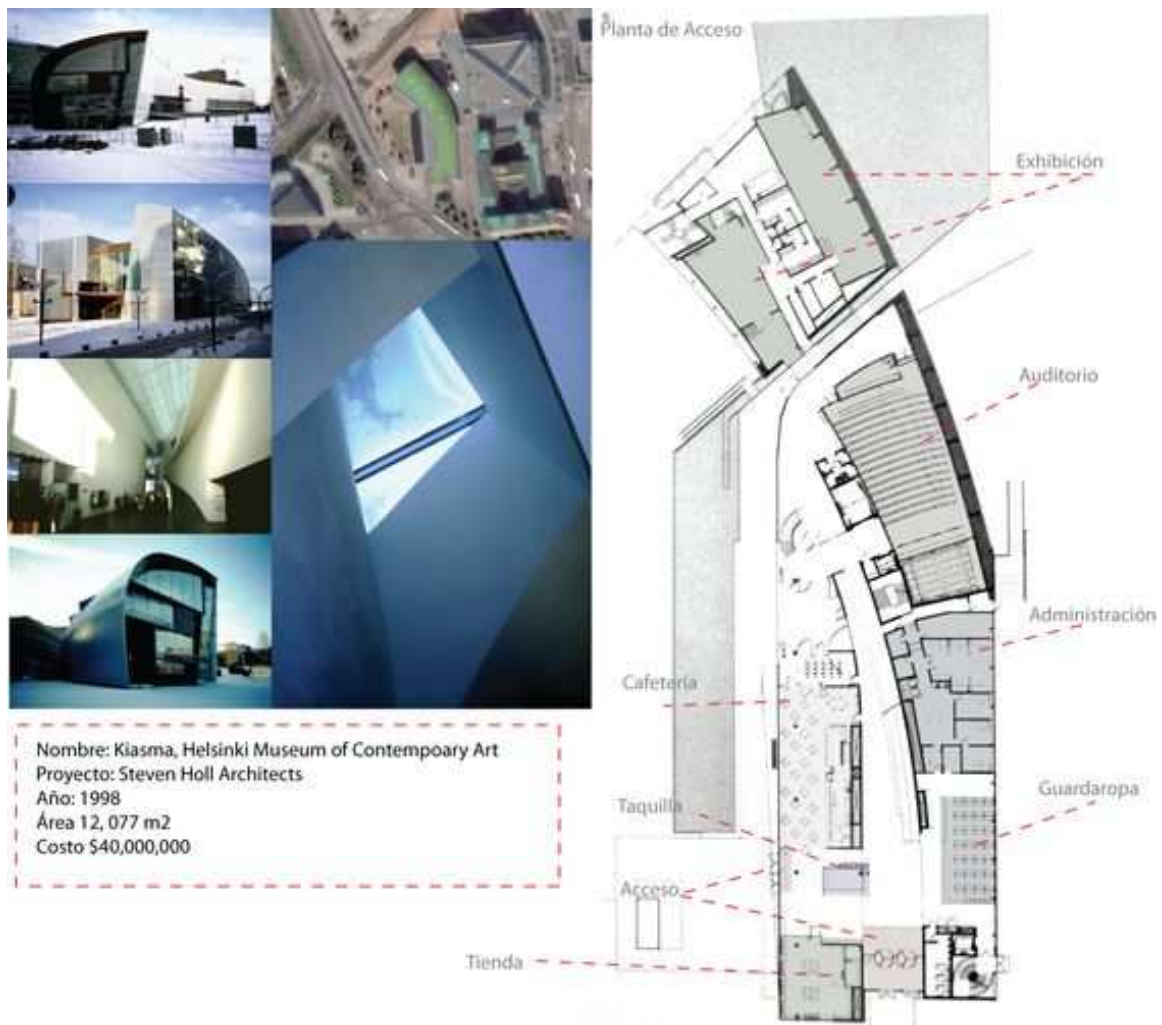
Planta Arquitectónica Museo Kiasma. <http://www.sfu.ca>
